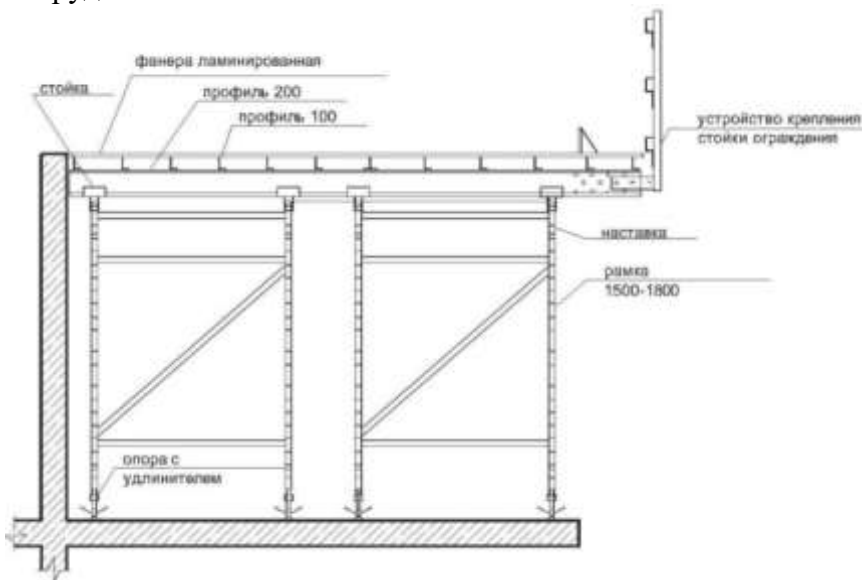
Устройство опалубки перекрытия с расстановкой опор
